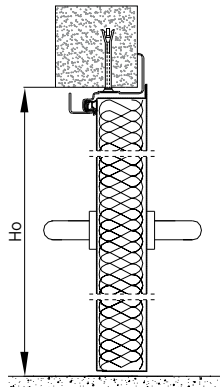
Montage mural d'un bloc-porte à un battant avec bâti angulaire - coupe verticale
